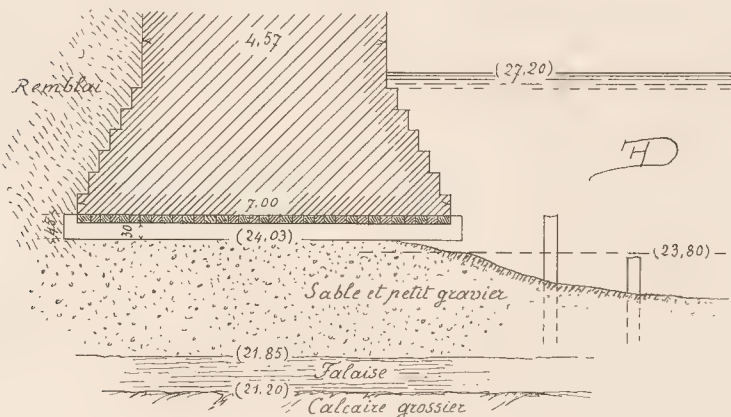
Grand Bras; fondation de la 1<sup>re</sup> pile de rive gauche.
